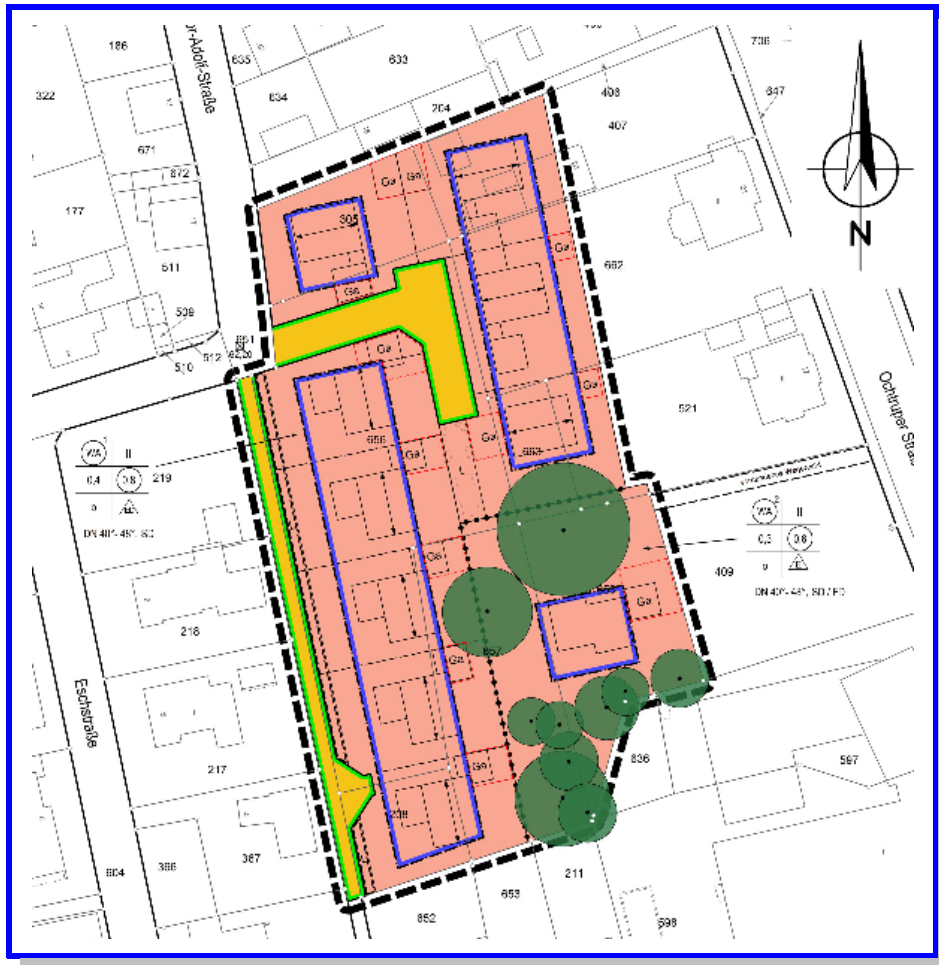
Bebauungsplan Nr. 47 (KREISSTADT STEINFURT 2017)
